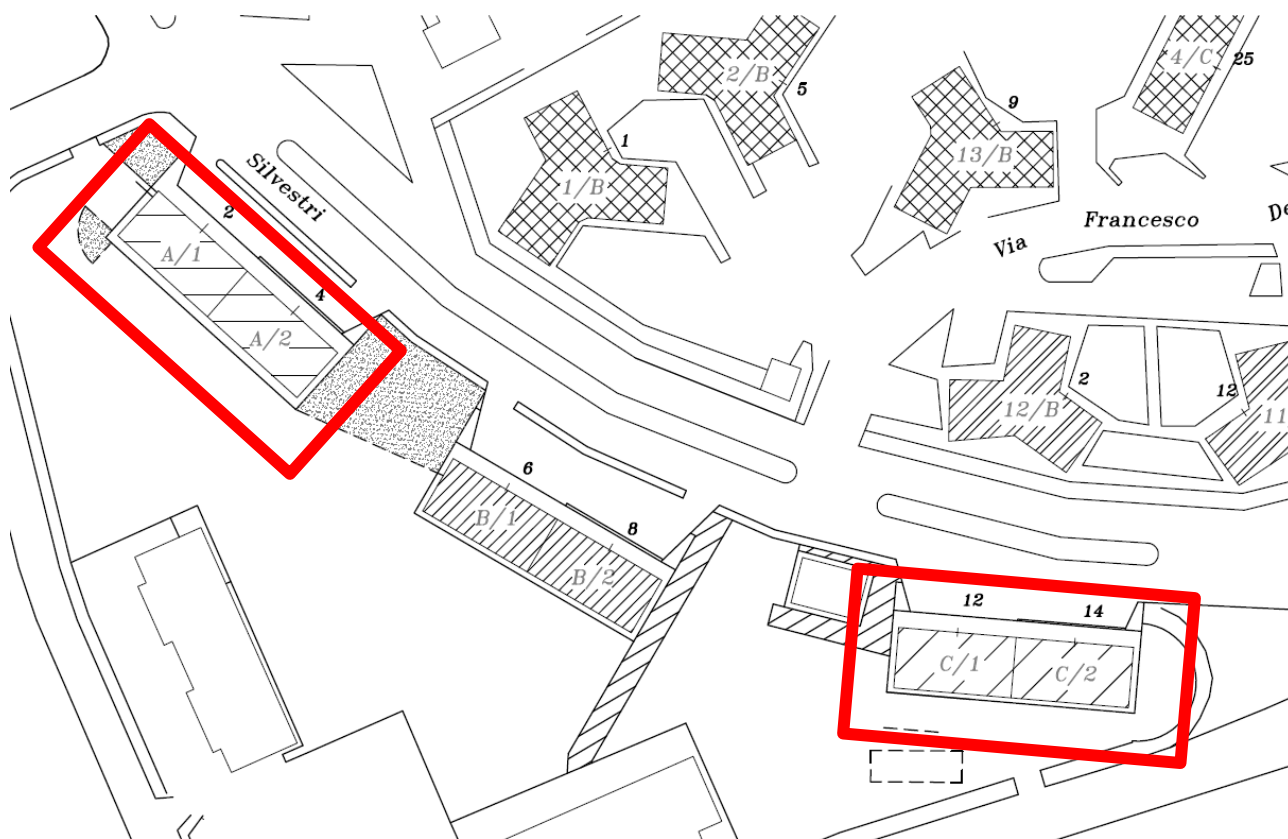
Lotto n.351 – Planimetria generale d'inquadramento.
